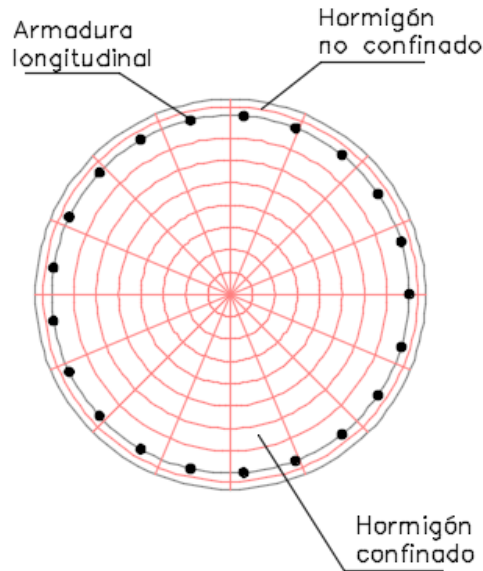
Discretización con fibras en columna circular de hormigón armado en puente de la clase VH-SATM.
